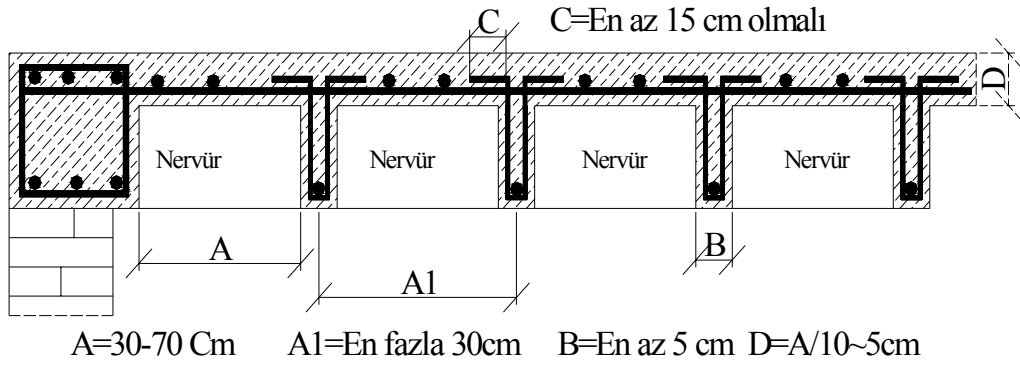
8: Kirişli betonarme döşeme ölçek 1/20
